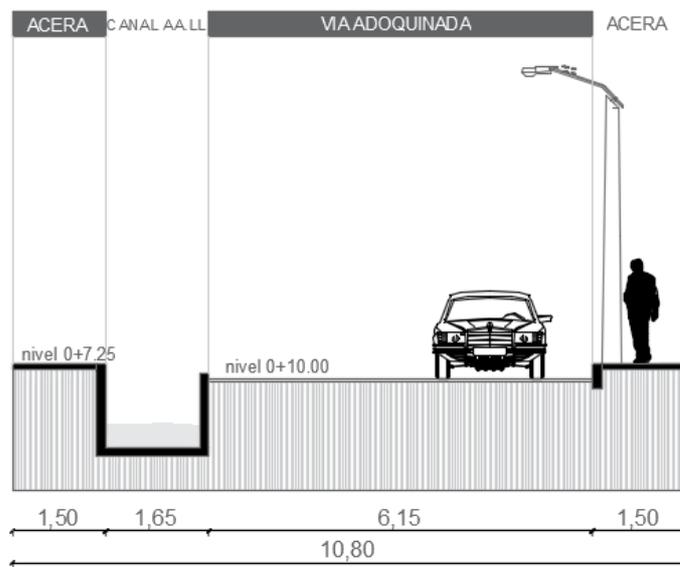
Plano Jerarquización de Vías – Elaborado por Tesista
